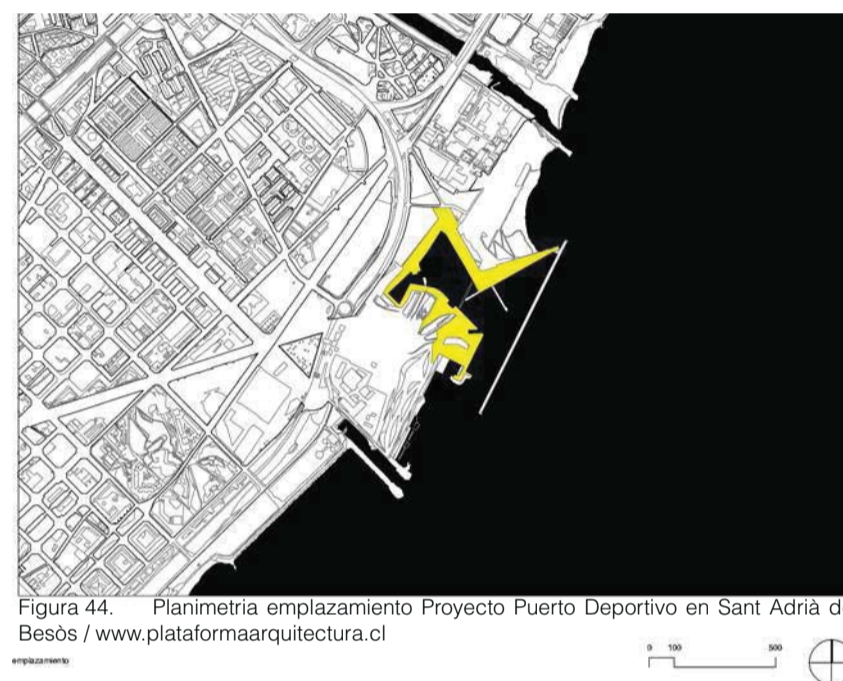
Planimetría emplazamiento Proyecto Puerto Deportivo en Sant Adrià de Besòs / www.plataformaarquitectura.cl
